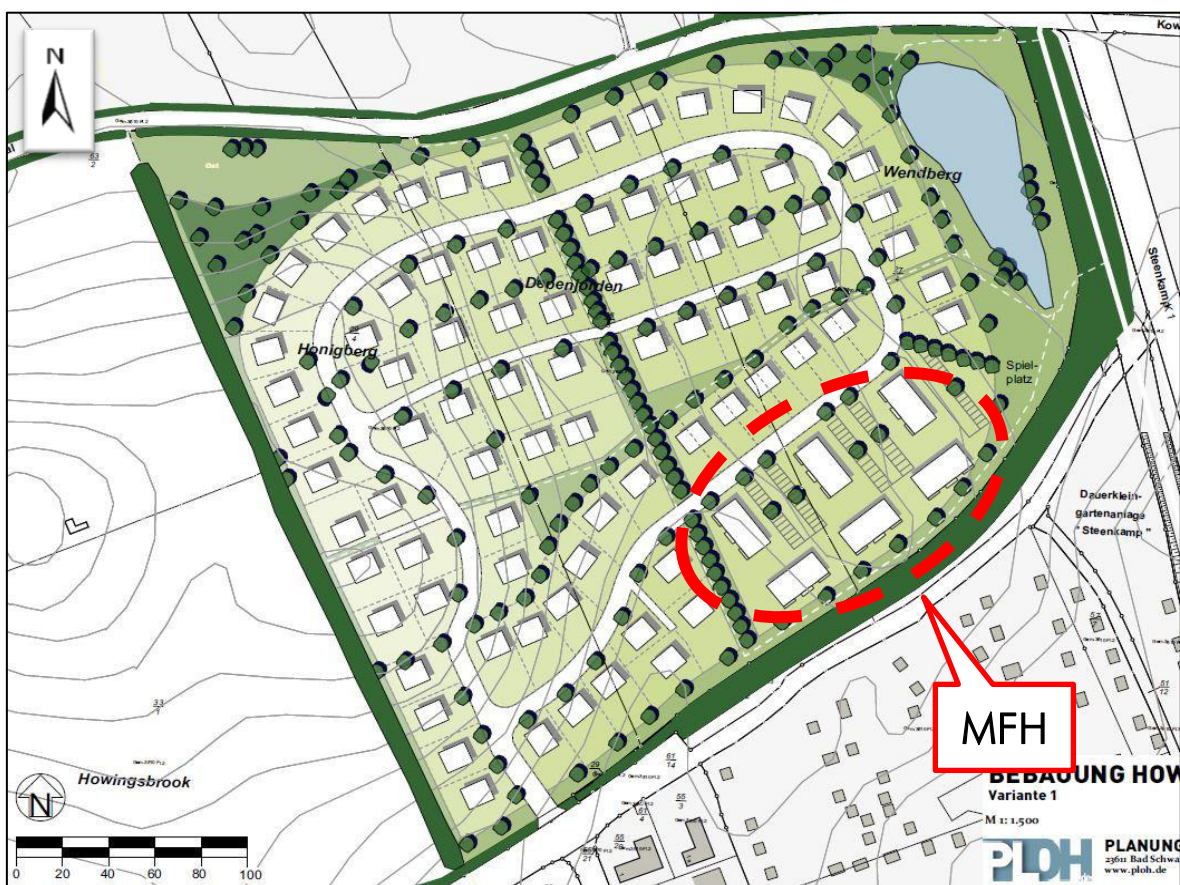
Ausschnitt aus dem Lageplan Bebauung Howingsbrook [12], redigiert H.S.W. GmbH
